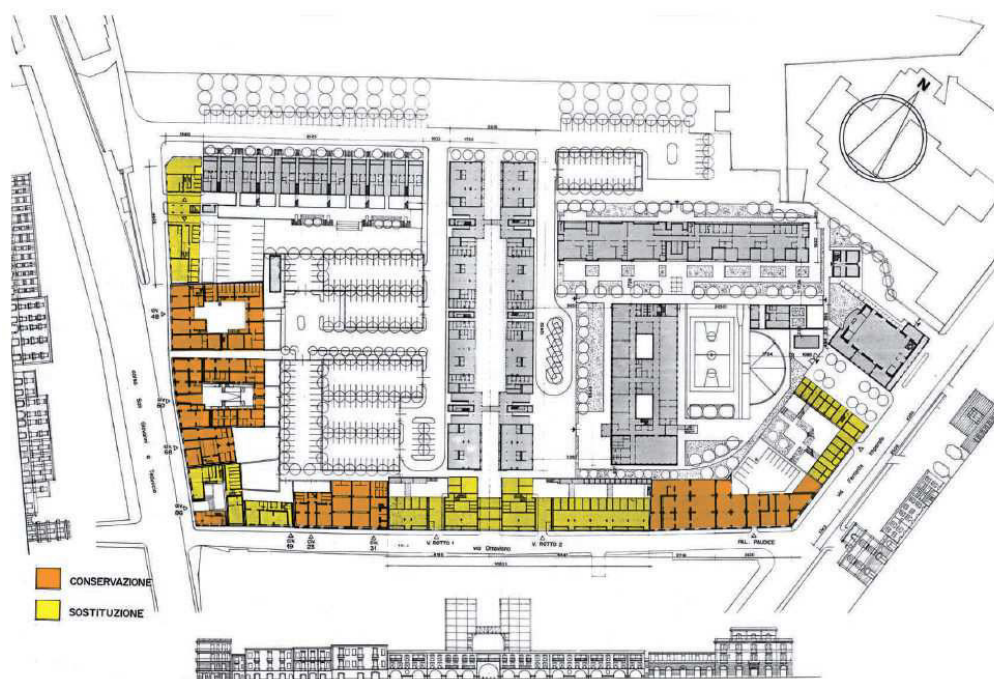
Piano di intervento su quartiere Pazzigno. Individuazione delle aree di conservazione e sostituzione
